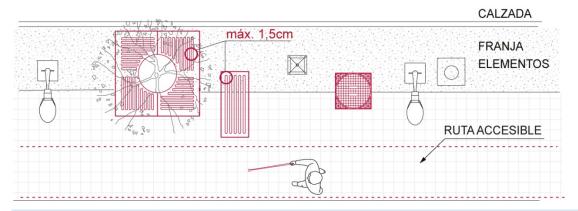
Disposición y orden de elementos tipo rejillas en la acera
